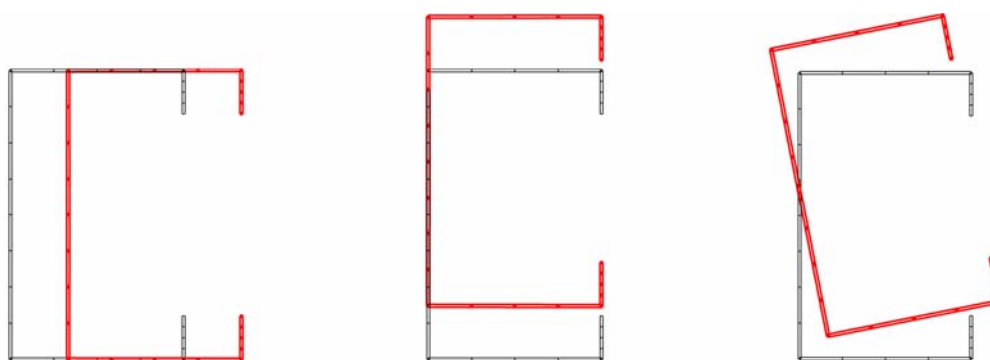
Instabilité globales d'une section en C uniformément comprimée
